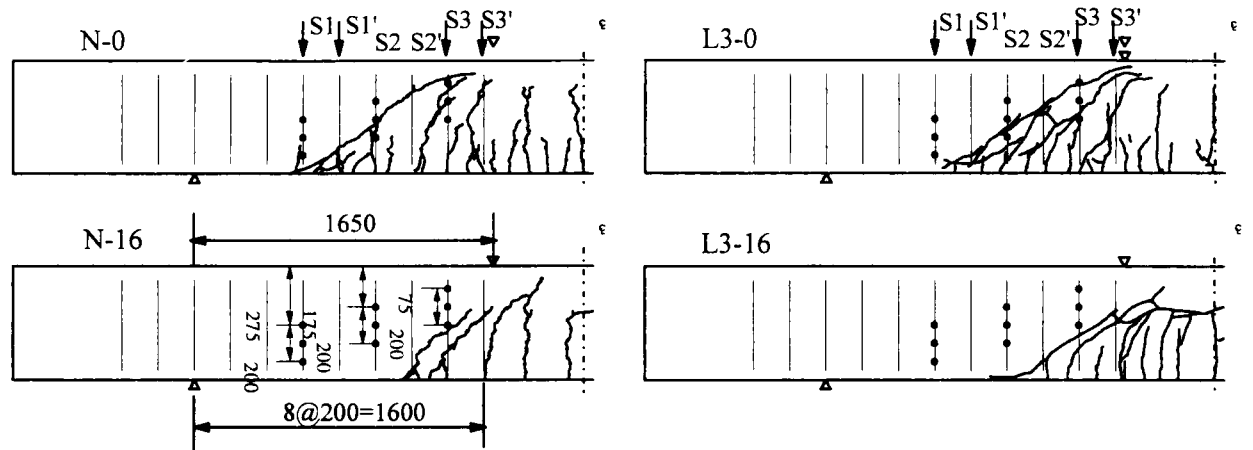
供試体に発生したひび割れの状況（図中の寸法の単位はmm）
